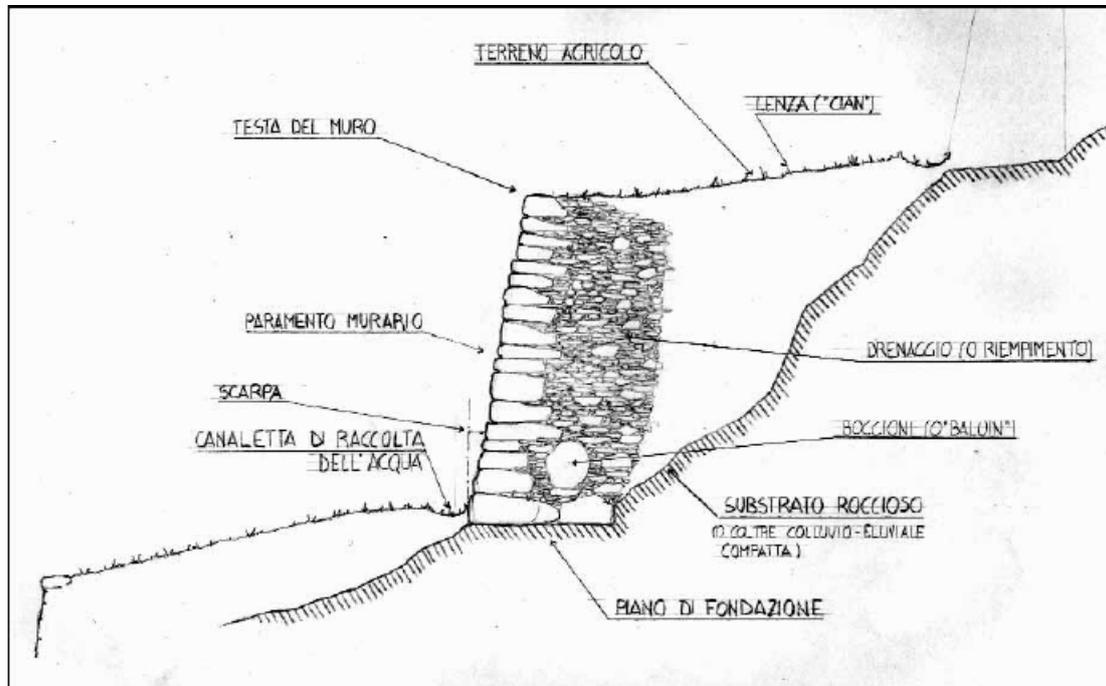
tipologico per costruzione di muretto a secco
